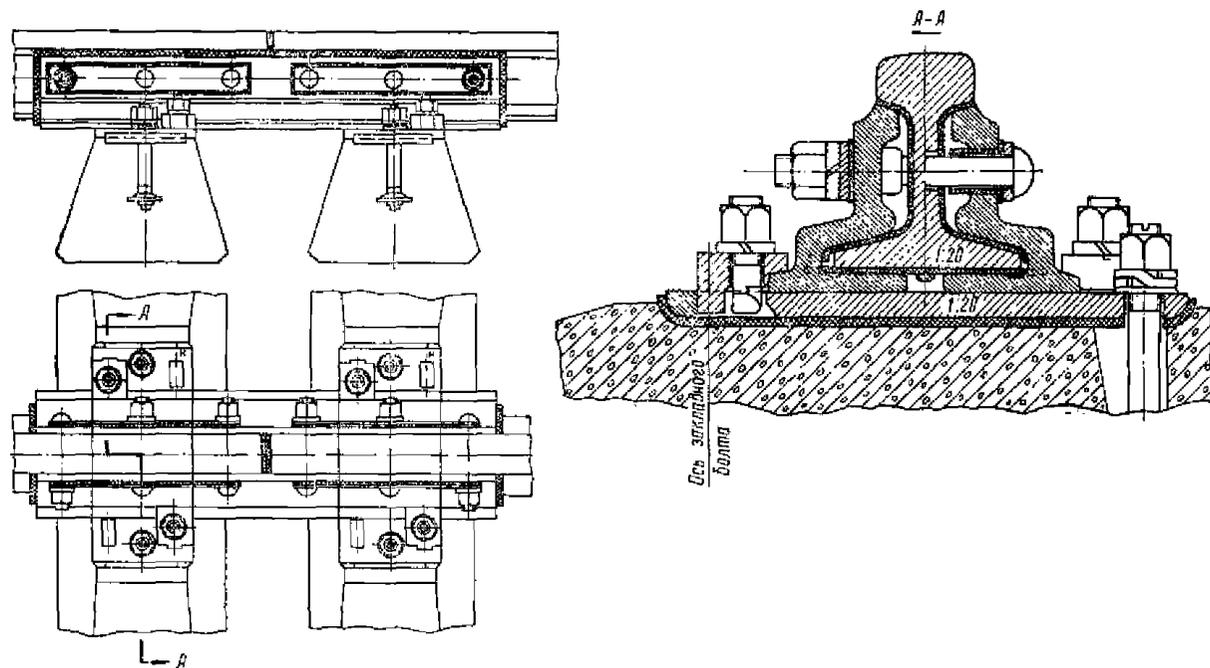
Изолирующий стык рельсов для пути на железобетонных шпалах с болтовым креплением подкладок
